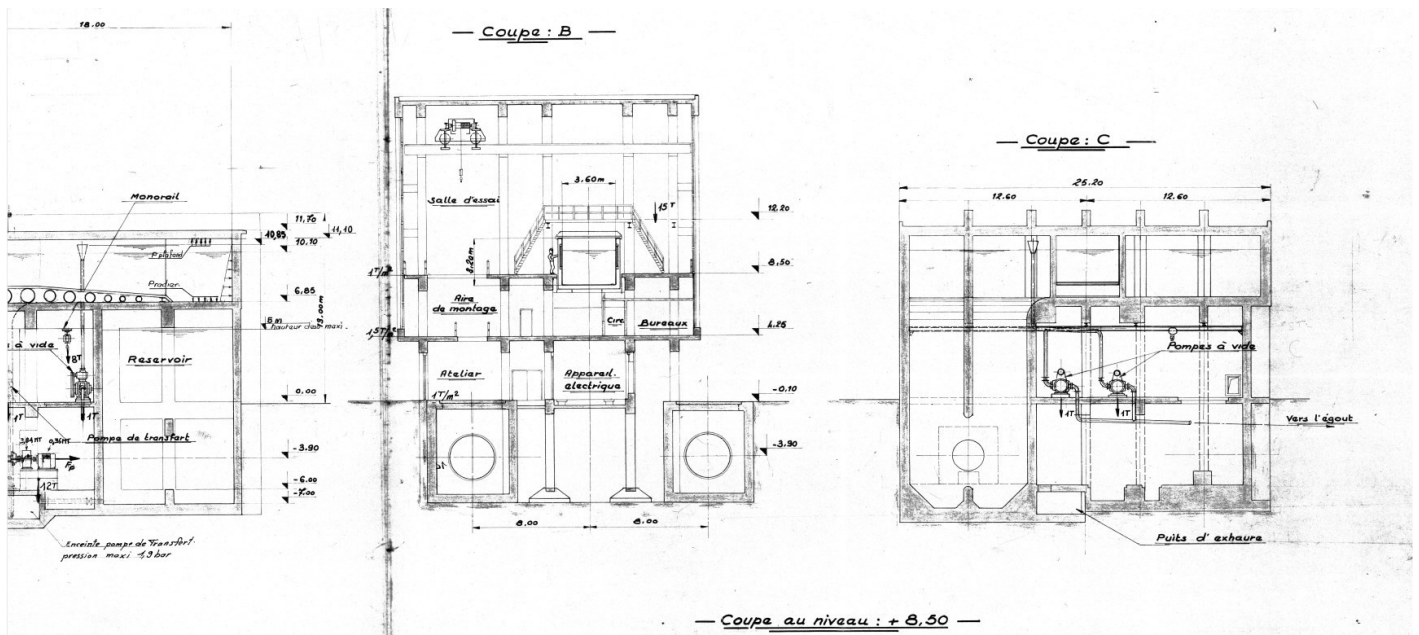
Viste trasversali del layout del canale di circolazione dell'INM
